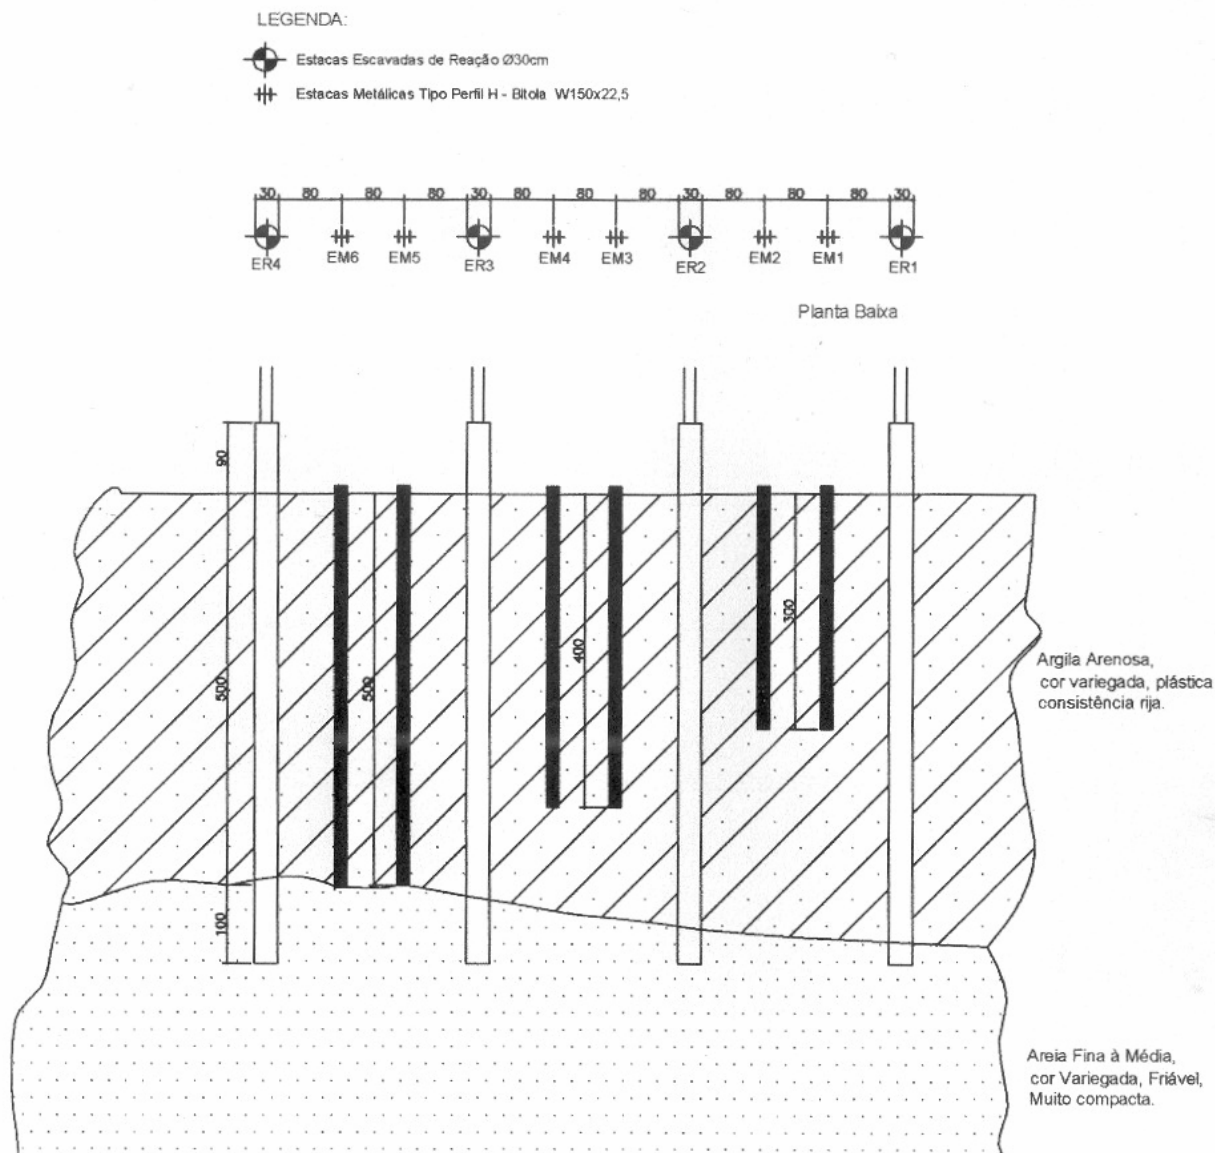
Croqui com planta baixa e vista das estacas no campo experimental
